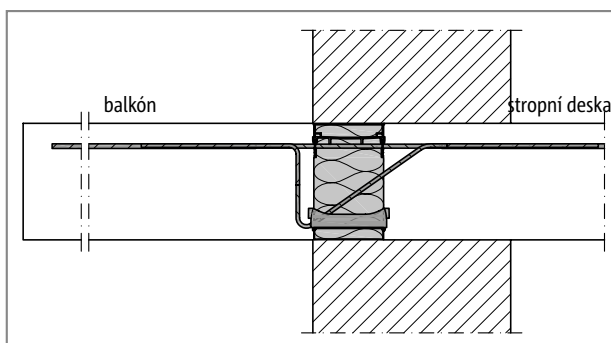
Schöck Isokorb® typ KXT: Balkón na zalomené fasádě (částečně zapuštěný)
